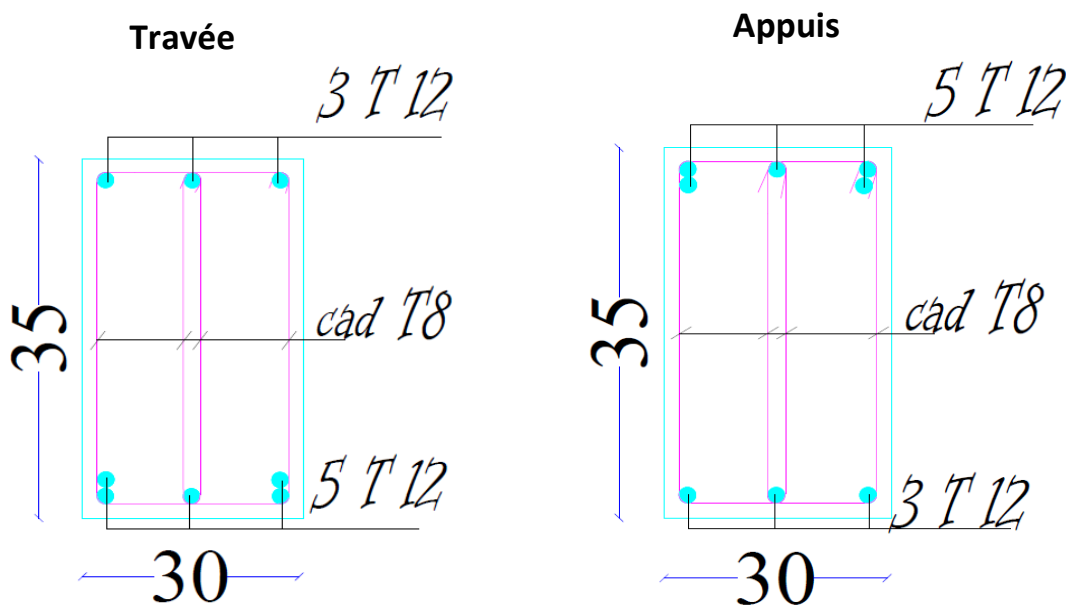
Ferrailage de la poutre secondaire (30×35)
